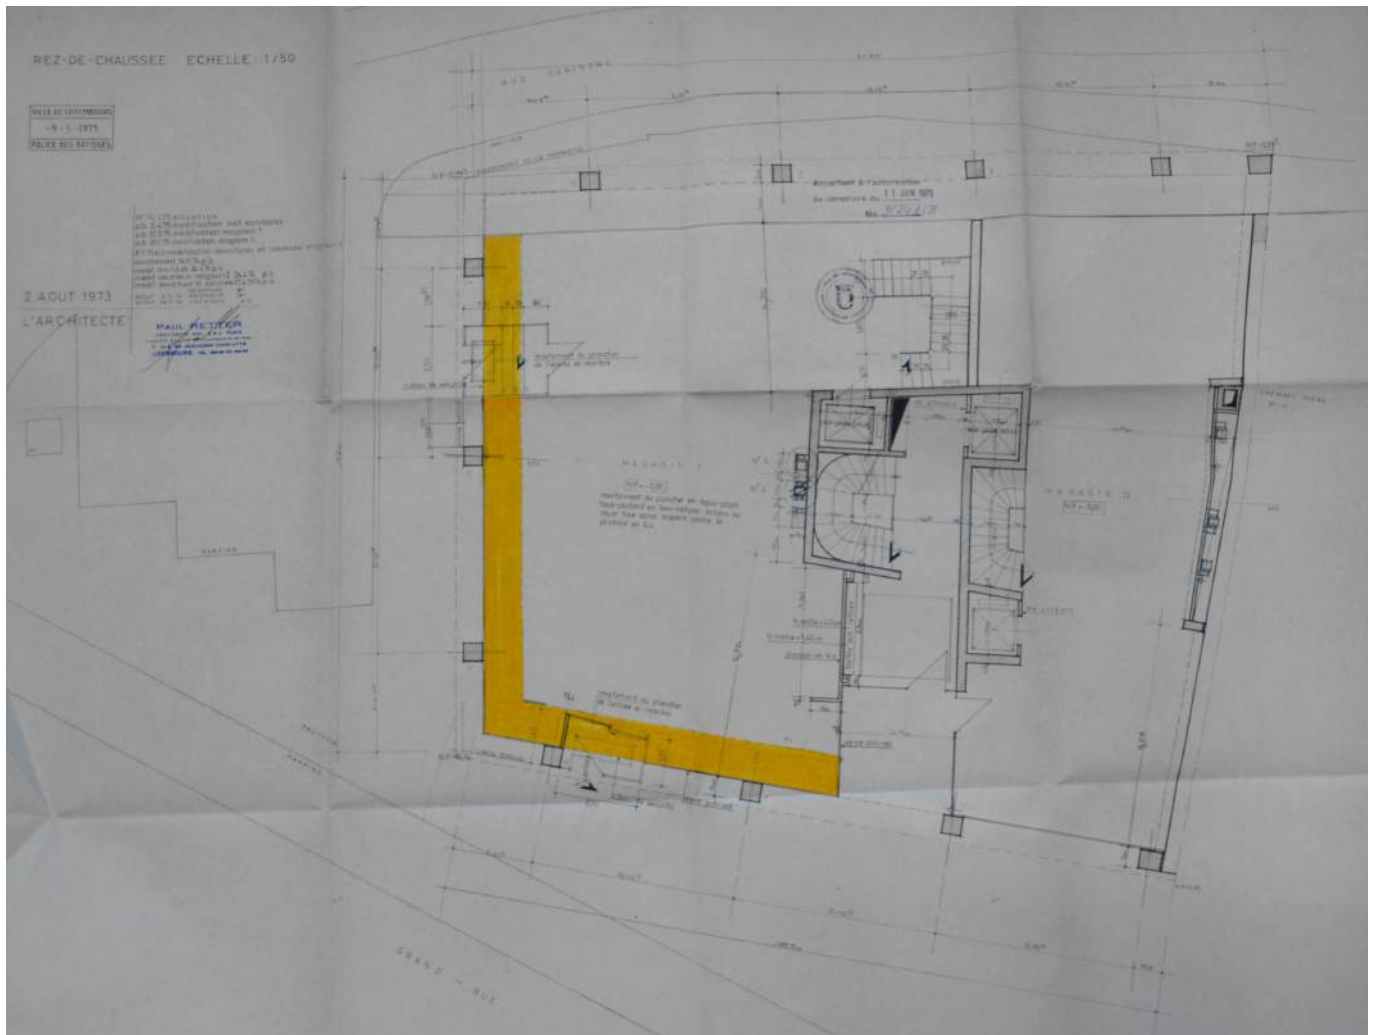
Grundriss Erdgeschoß, Gelb: 1972 geplanter Arkadengang (1975)
